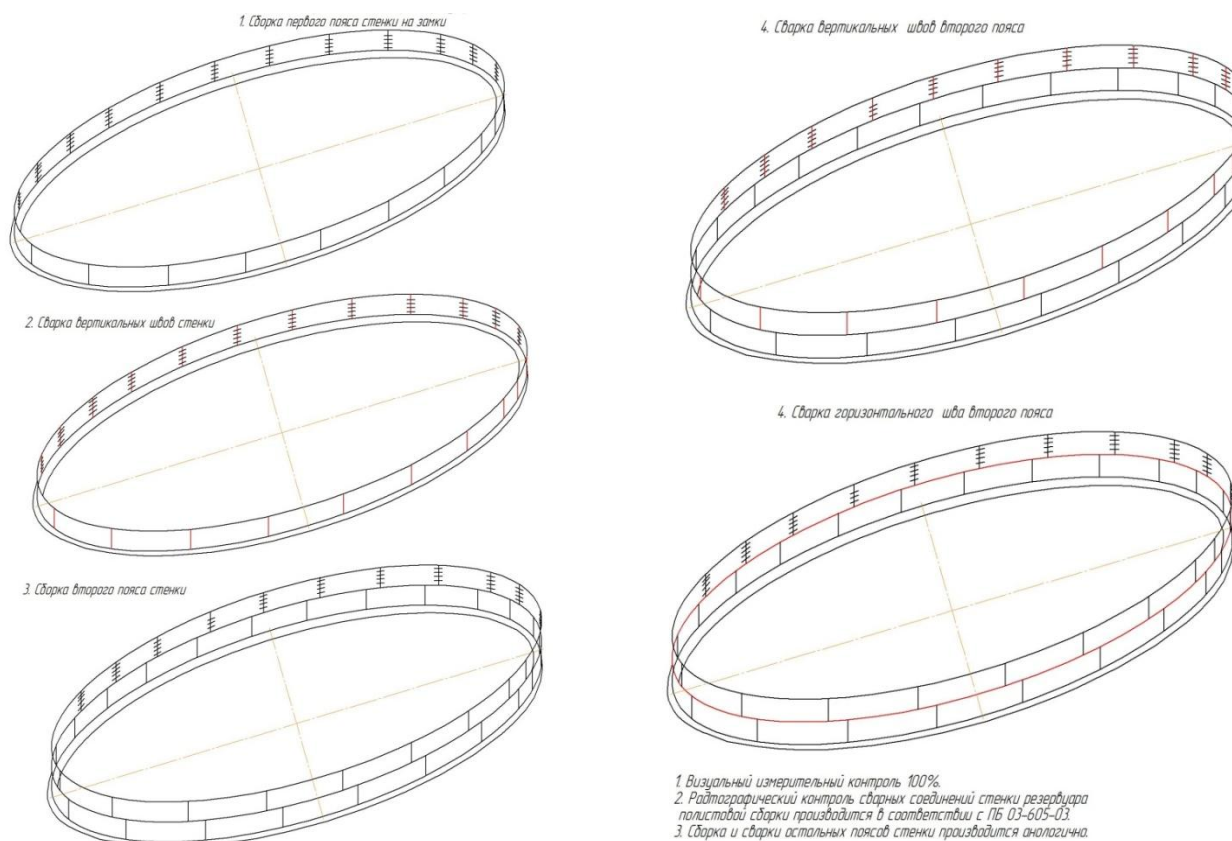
Технология сборки и сварки резервуара
